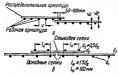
Стыки сварных сеток в нерабочем направлении: а — виахлестку; б — с укладкой легких
